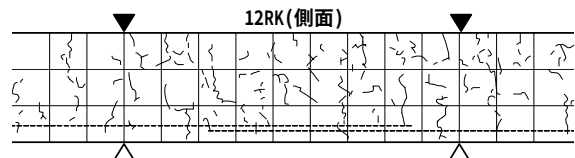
乾燥収縮ひび割れ(材齢12週)
